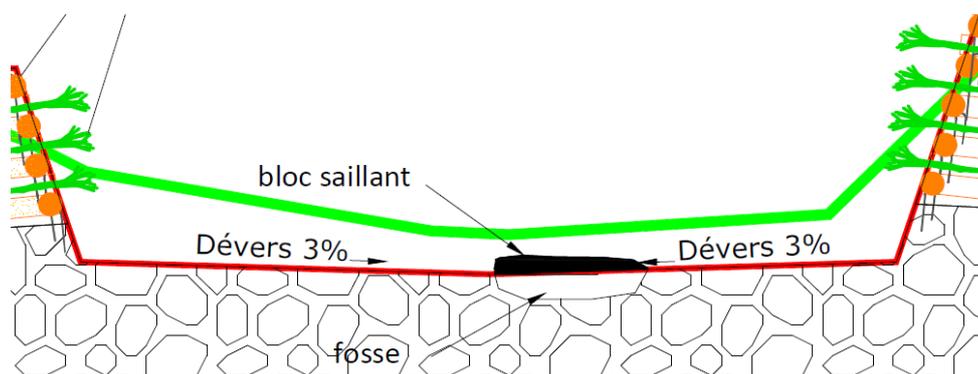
Extrait d'une coupe type au droit d'un des seuils (HYD, 2020)
